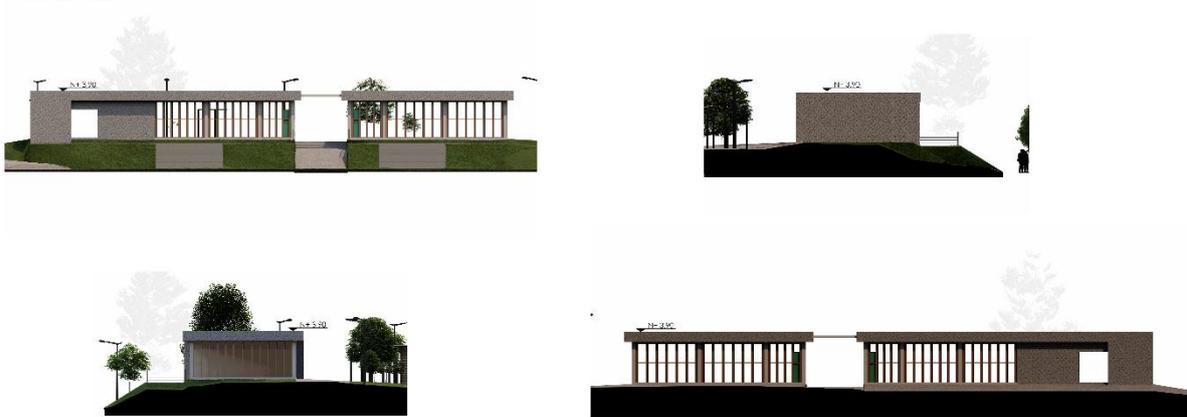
Fachadas Bloque Servicios y Aulas Abiertas
